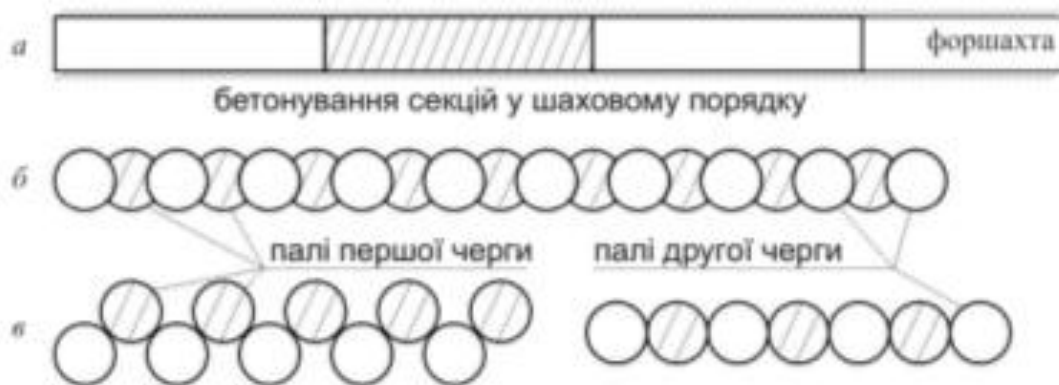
Схема конструкцій, що влаштовуються способом «стіна в ґрунті»: а - монолітна траншейна «стіна в ґрунті»; б - пальова «стіна в ґрунті» з буросічних палів; в - пальова «стіна в ґрунті» з буродотичних палів
